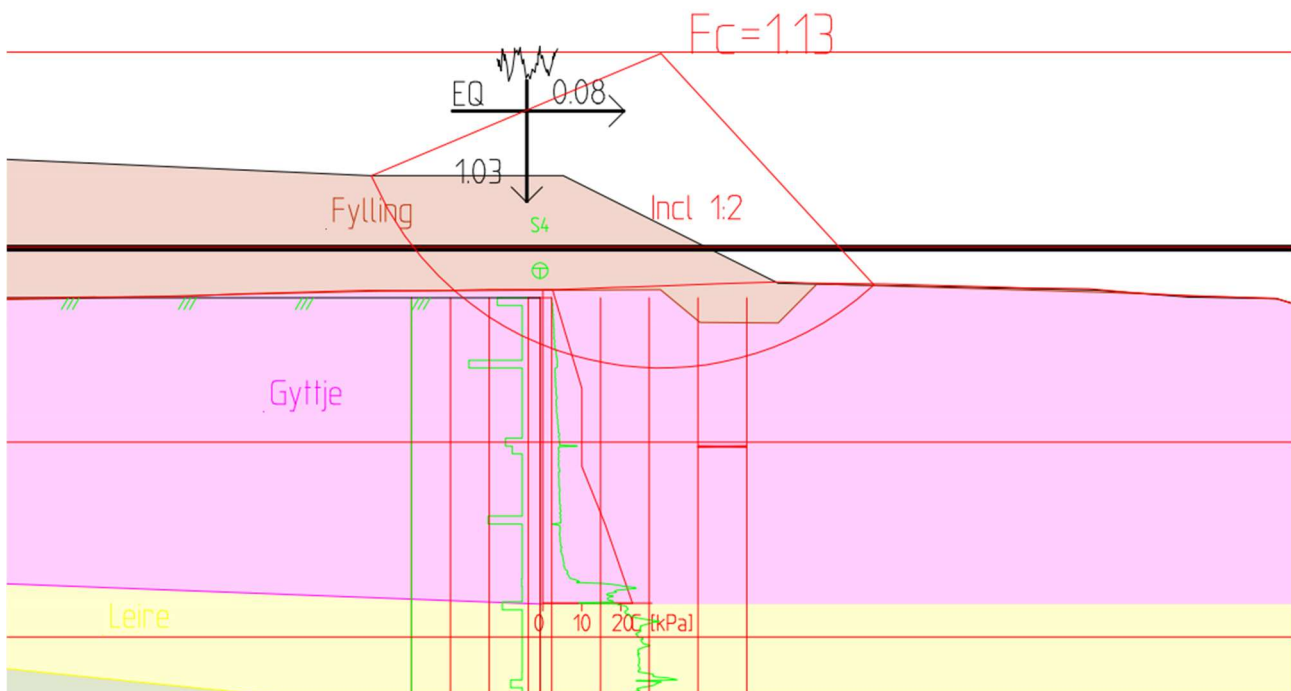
Utsnitt fra stabilitetsberegning med oppfylling til kt. + 1,85.
